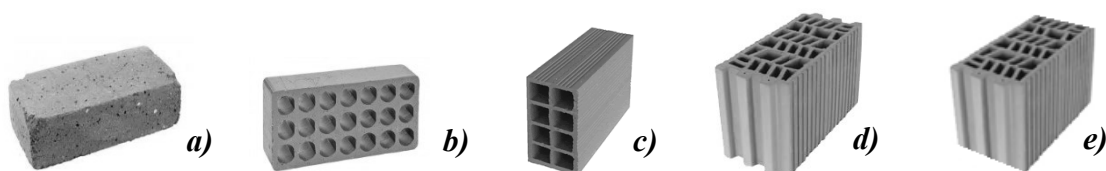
Unidades de alvenaria recorrentes em Portugal: a)Tijolo Maciço; b)Tijolo Perfurado; c)Tijolo de furação horizontal; d)Tijolo de furação vertical com encaixe; e)Tijolo de furação vertical sem encaixe; [48].
